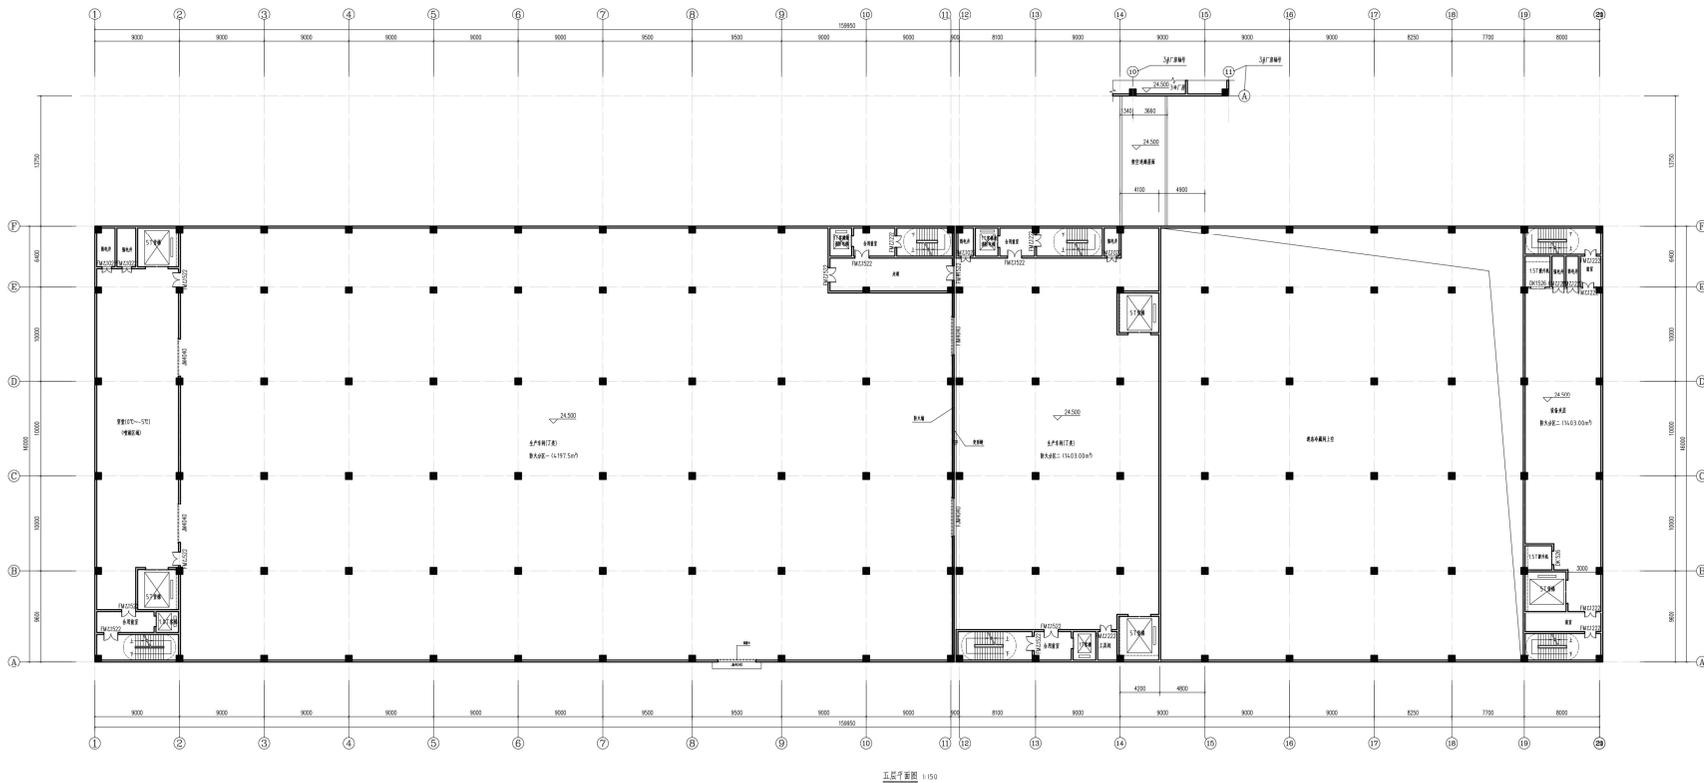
1#厂房三层上空及 2#厂房五层平面布置图
